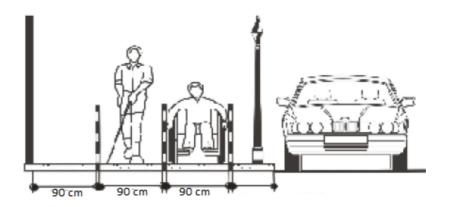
Distancia entre bolardos, horquillas o pilarotes. (Tomado de (González, 2008))
